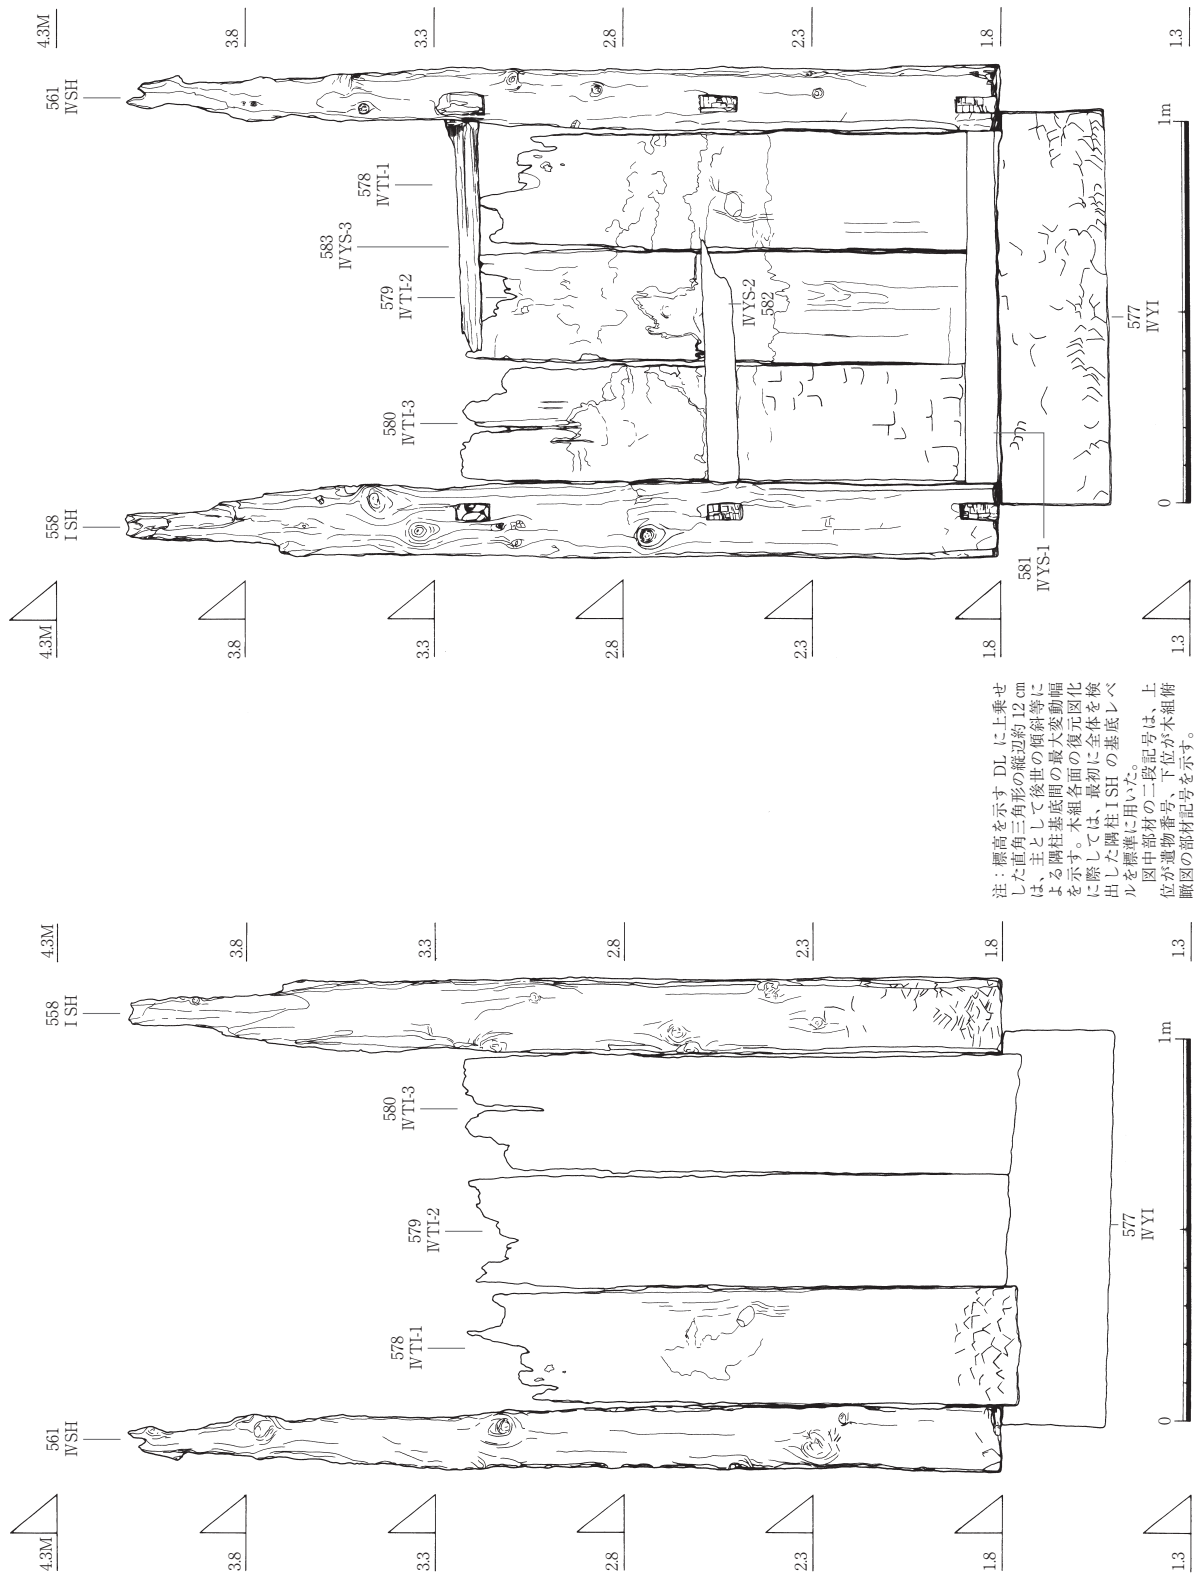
D区 SE1 井戸跡 木組第2面 復元正面図 (S : 1/20)
